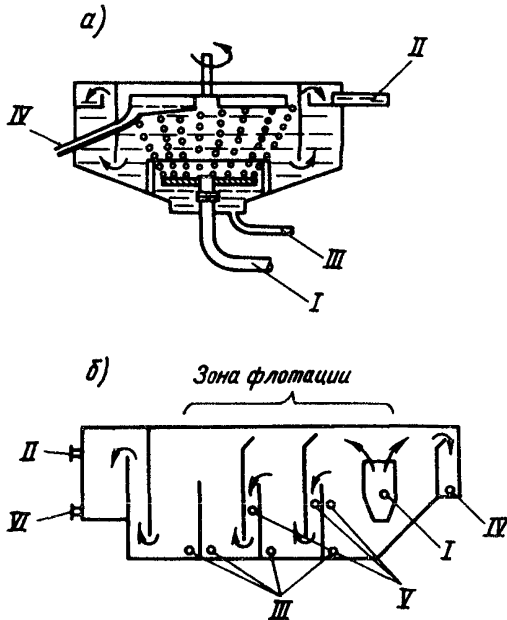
Схемы круглого железобетонного (а) и прямоугольного металлического (б) флотаторов:
